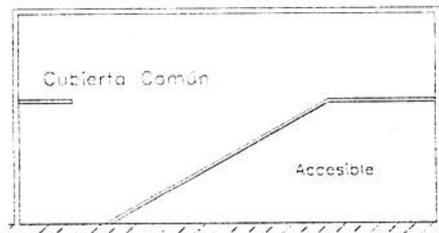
PLANTA INFERIOR ESCALERA BAJO ESPACIO ACCESIBLE
